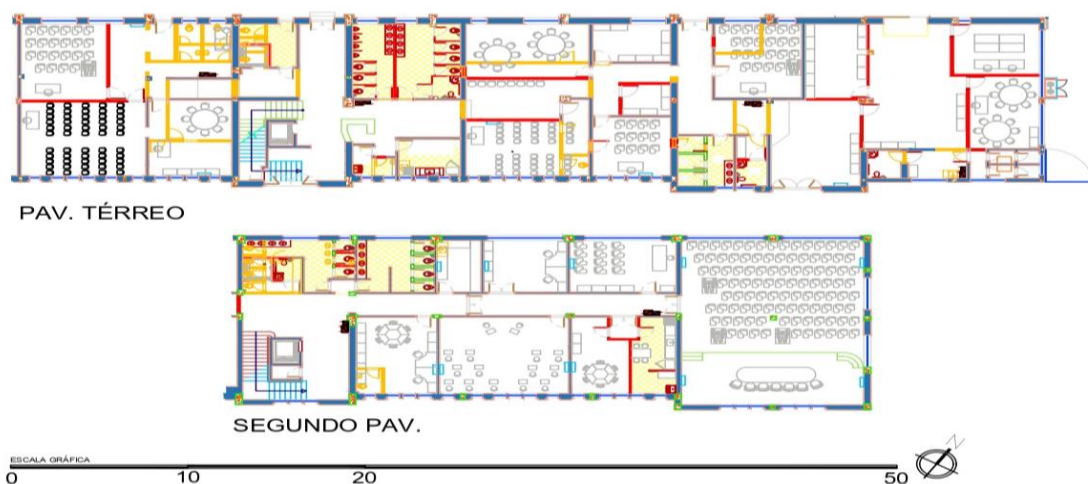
Planta baixa das associações, pavimento térreo e segundo pavimento (Produção da Autora).
